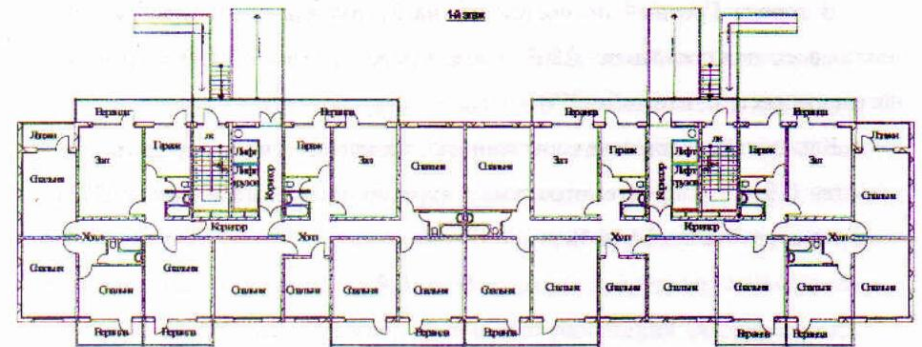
Двухсекционный жилой дом (5-6)+(5-6) комнатными квартирами. План 1-го этажа
